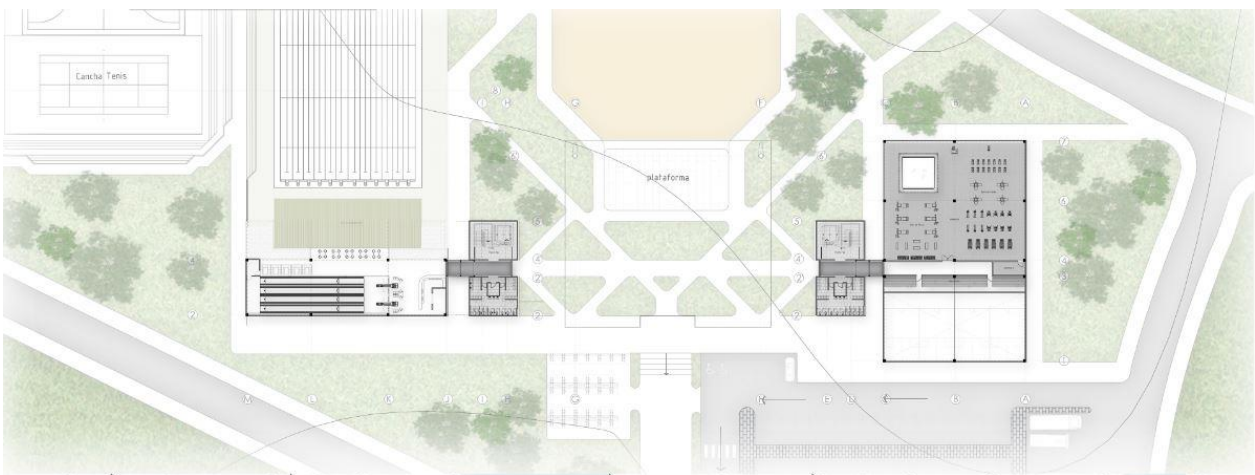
Planta 2do nivel / Autoría propia (2017)
